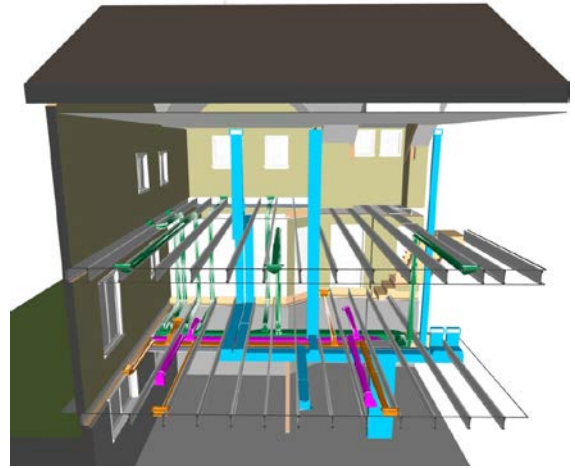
Exemple de la coordination du plan des conduits avec le plan de l'ossature afin de réduire au minimum les angles de 90 degrés
